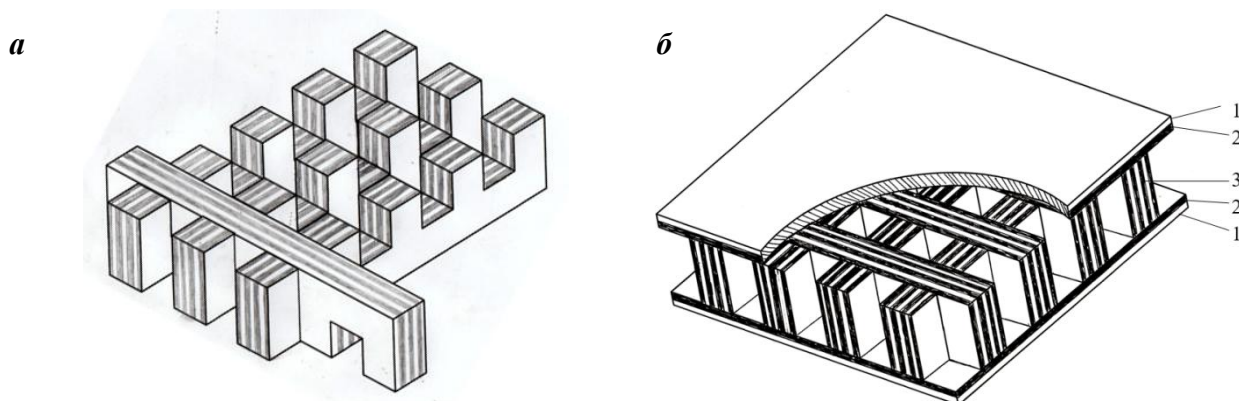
Конструкция фанерной панели с внутренним слоем в виде решётки: а – схема сборки решетчатой конструкции; б – схема сборки панели; 1 – продольные слои шпона; 2 – поперечные слои шпона; 3 – решётчатая конструкция из реек от форматной обрезки фанеры
